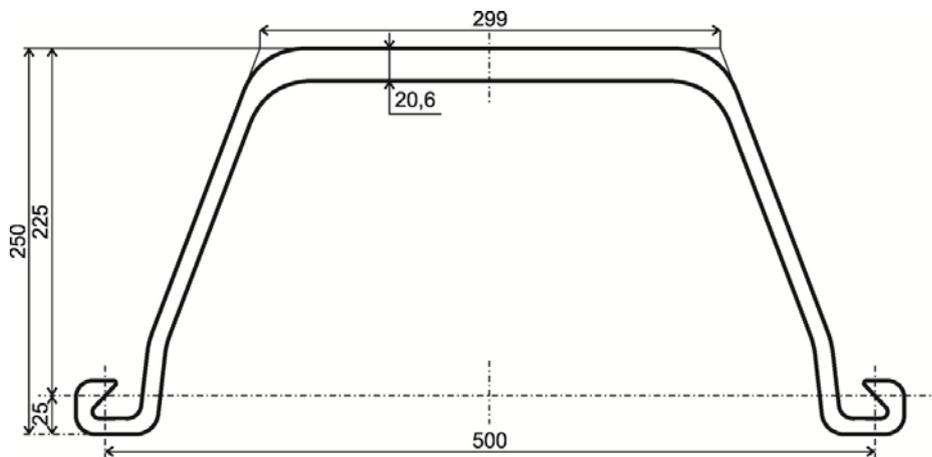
Профиль стального шпунта L5 S (Unimetal)
